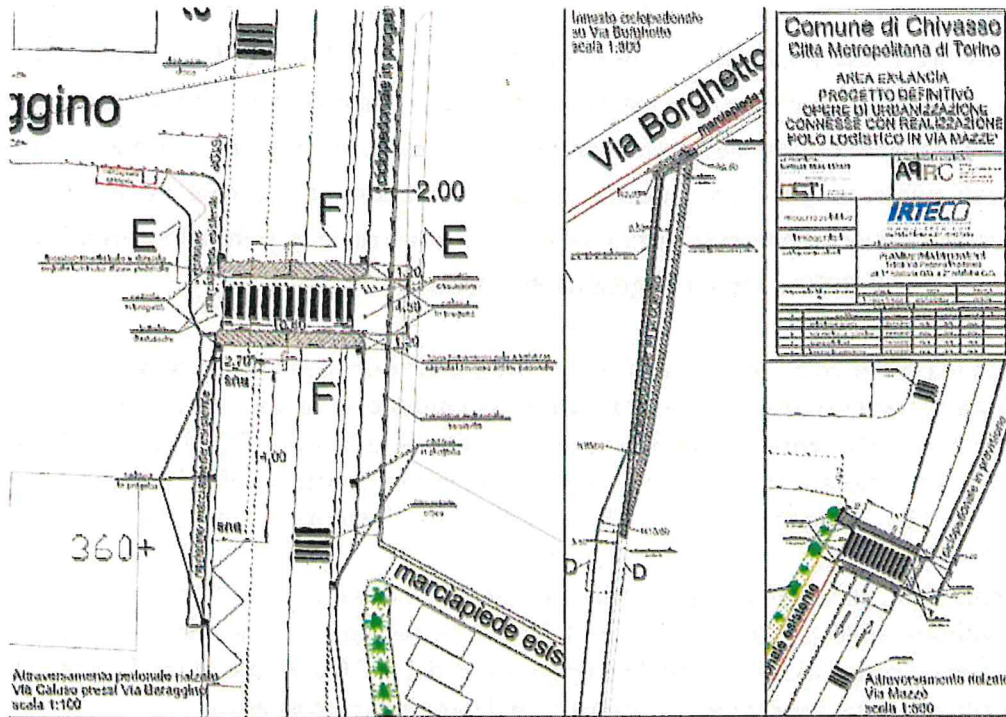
Planimetria attraversamento ciclopedonale S.P. 81
